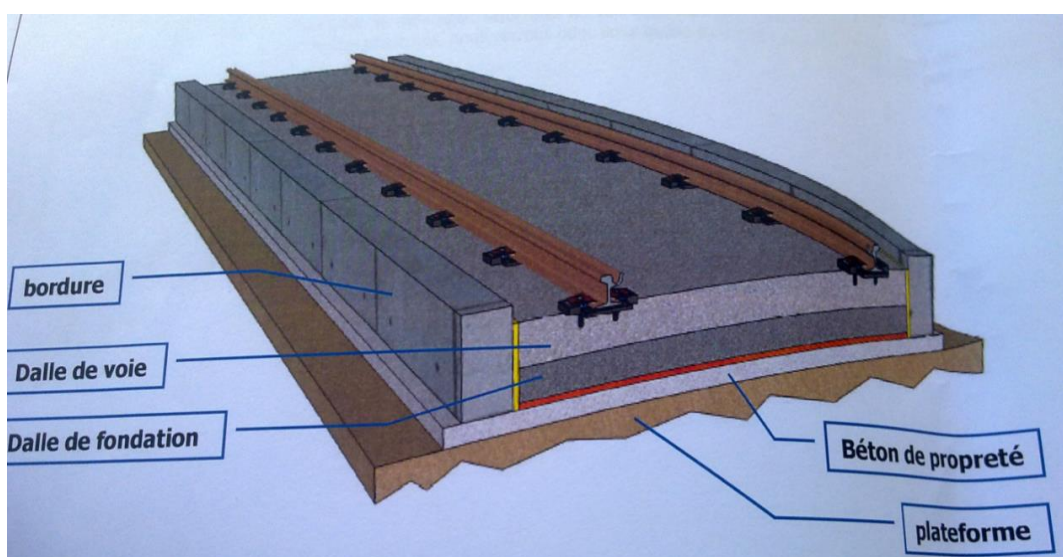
Coupe d'une voie de tramway avec éléments modulaires
